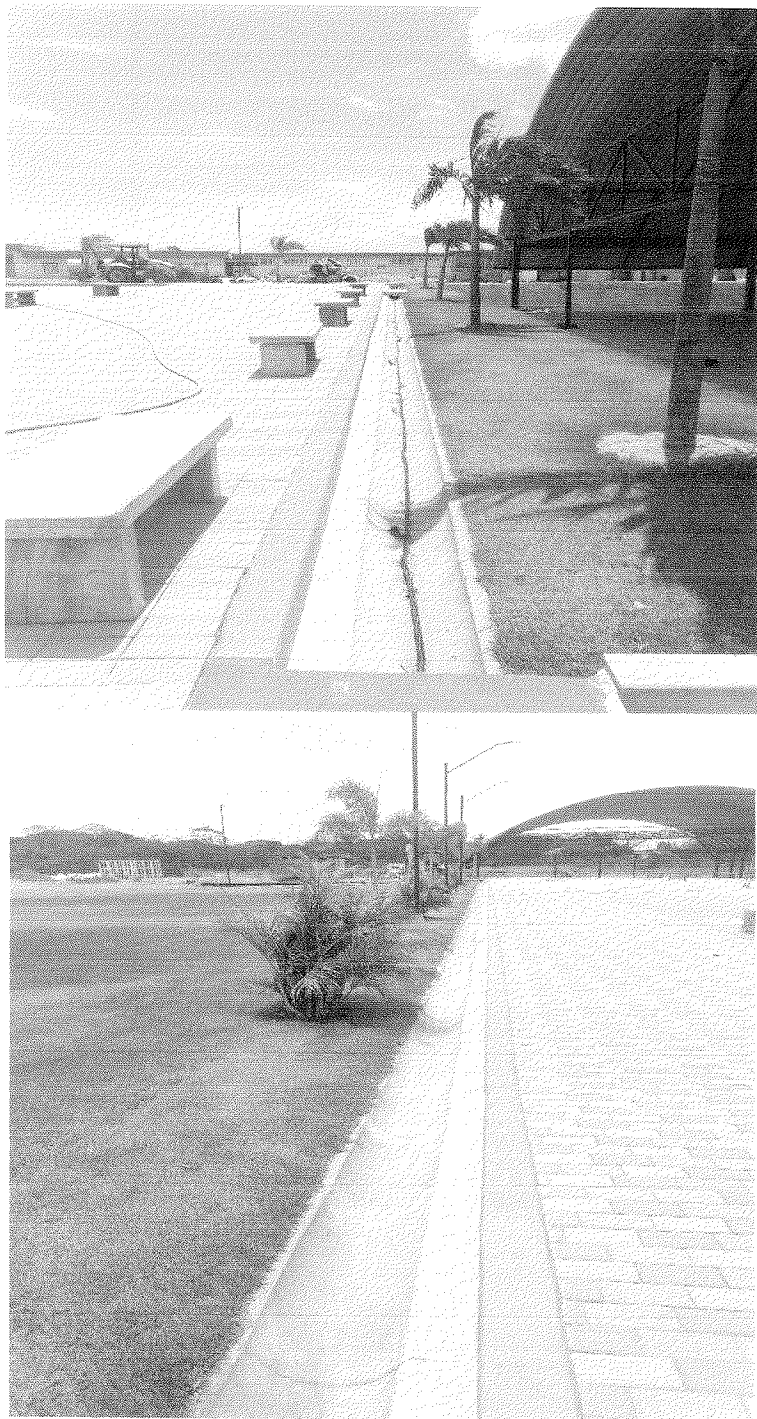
y 2 – Media caña entre el acceso, la cancha multiusos y el área verde aún por desarrollar. Van direccionadas y se conectan a la línea pluvial existente
